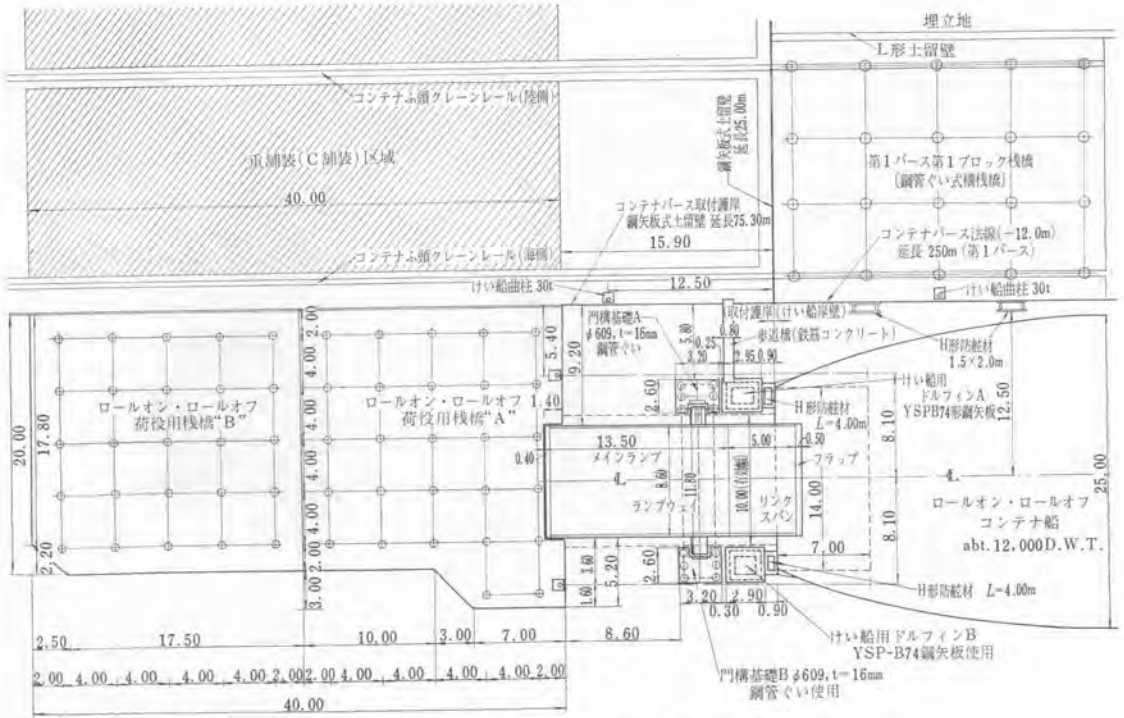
ロールオン・ロールオフ式けい船施設配置平面図
